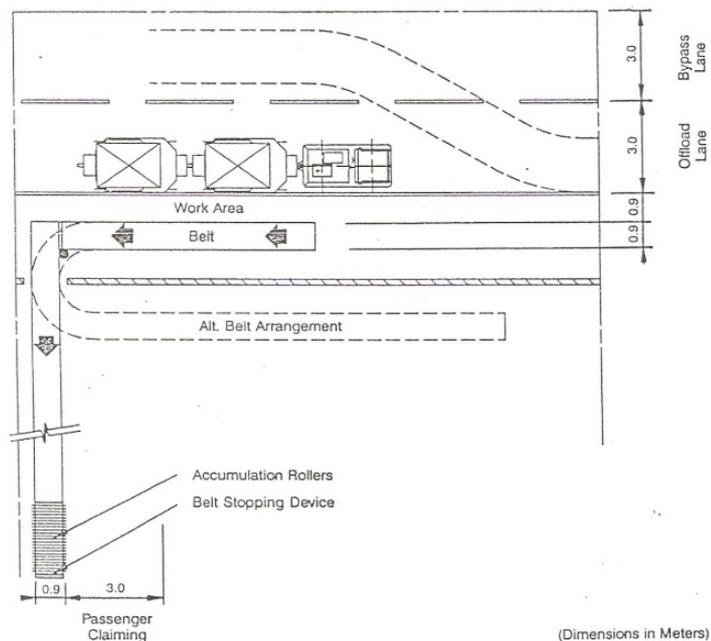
Planta: área de descarga e restituição de bagagem por cinta
